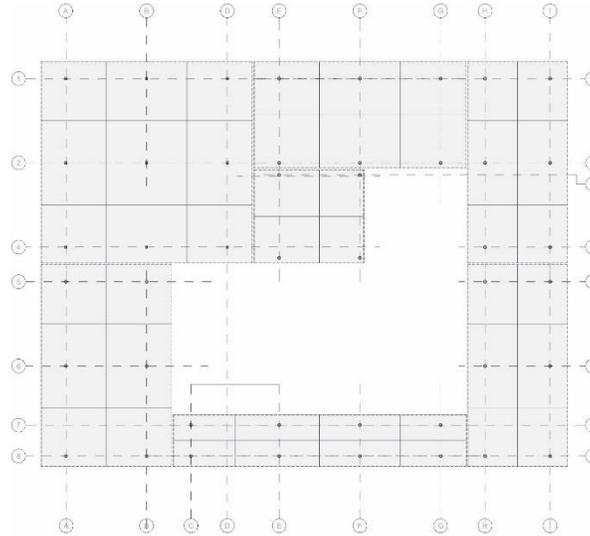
Plano de distribución de ejes y columnas dentro del sistema constructivo / Fuente: Elaboración propia
